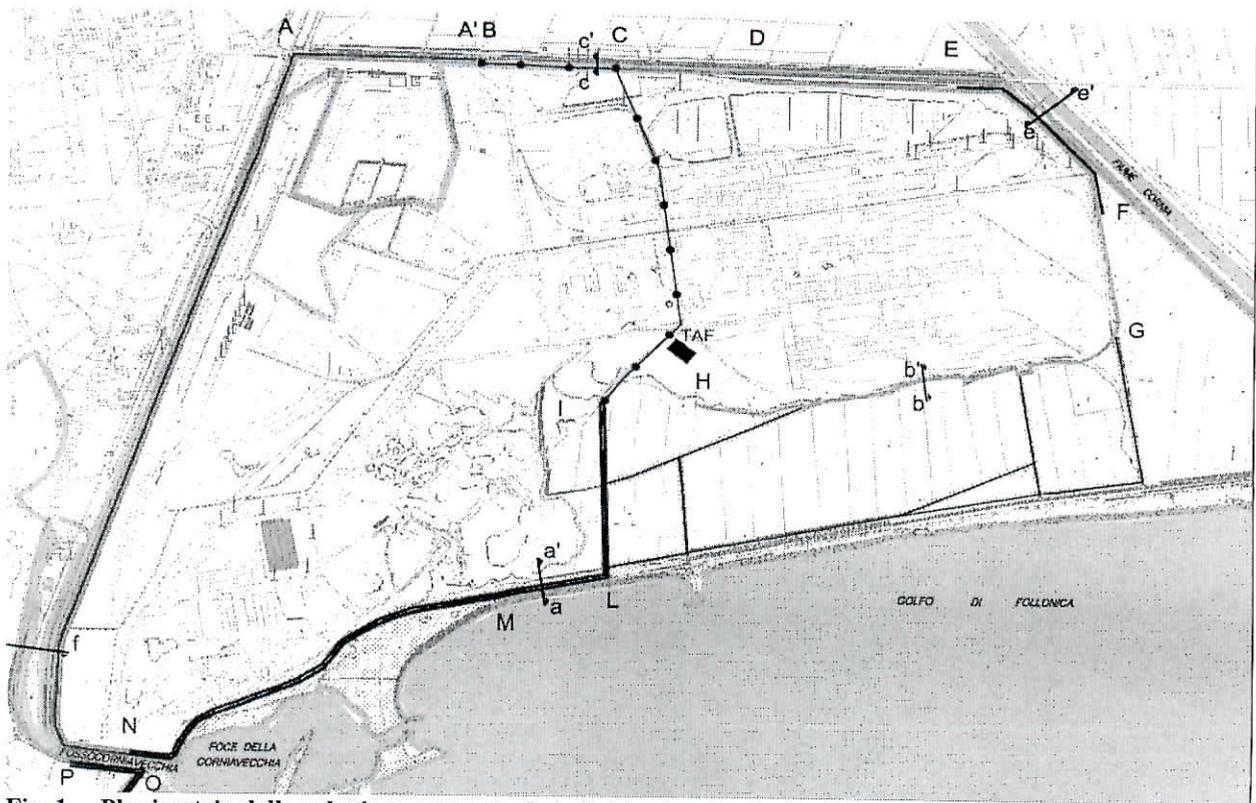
Planimetria della soluzione progettuale individuata estratta da elaborato 12TOS101_PL13
